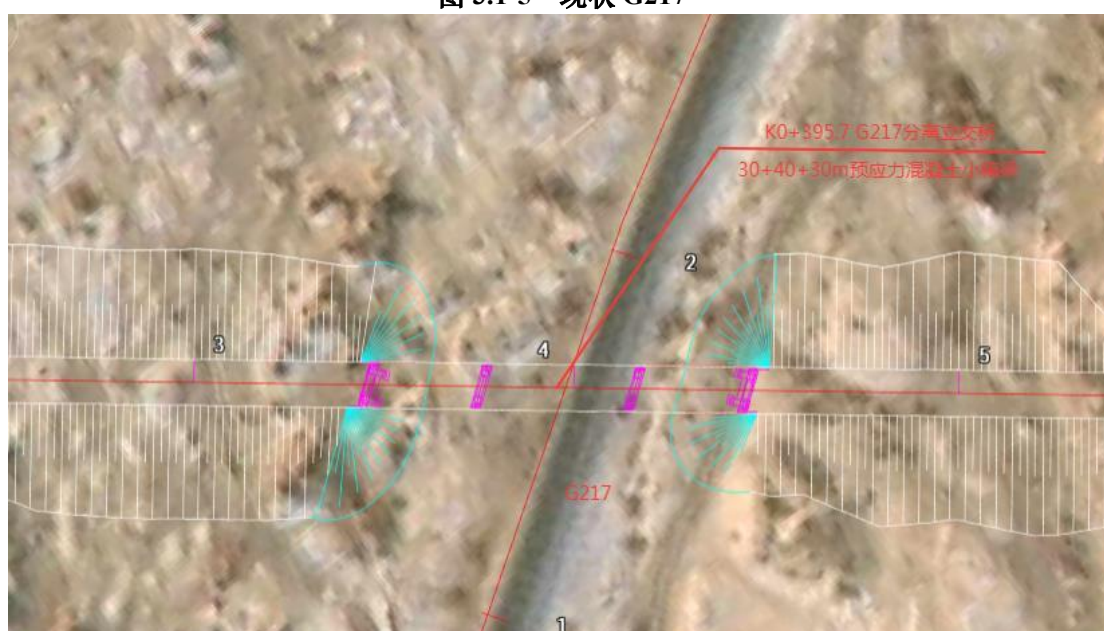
K0+395.7G217 分离立交桥桥位平面布置图
